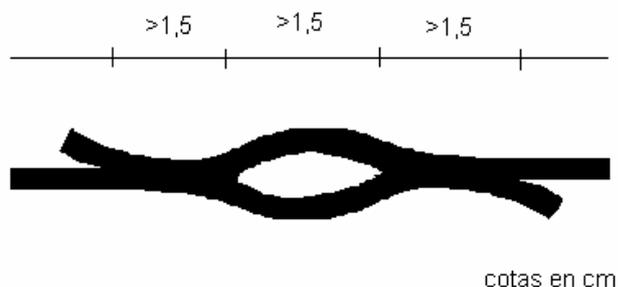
Dimensiones mínimas de la soldadura doble.
